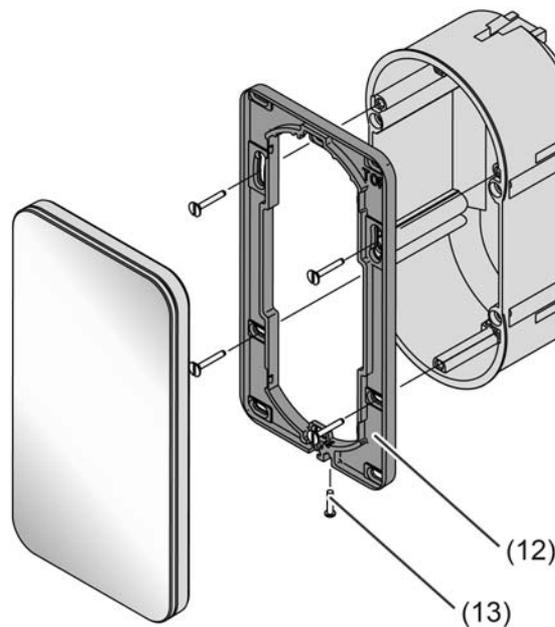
Gerätemontage eines Touch-Sensors Komfort
